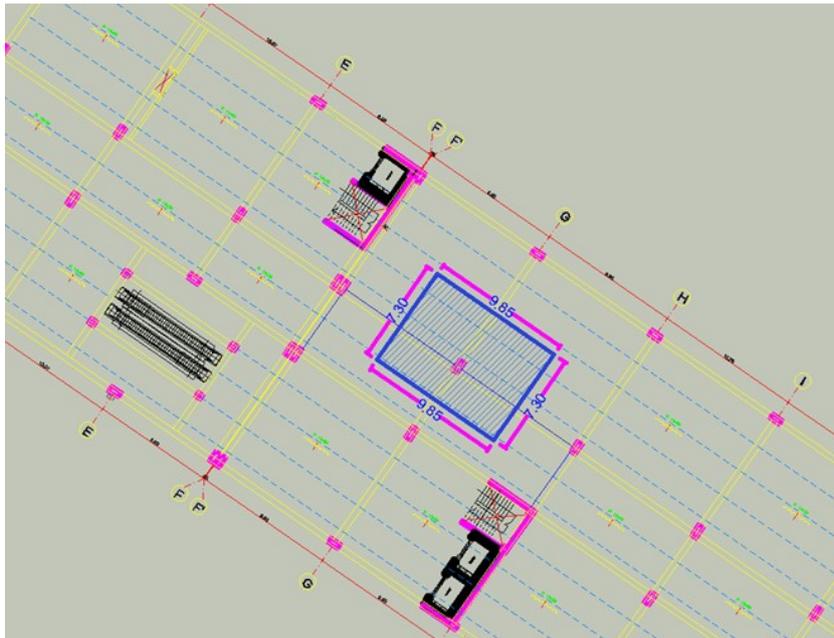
Pre – dimensionamiento de vigas Sector de Exposiciones
